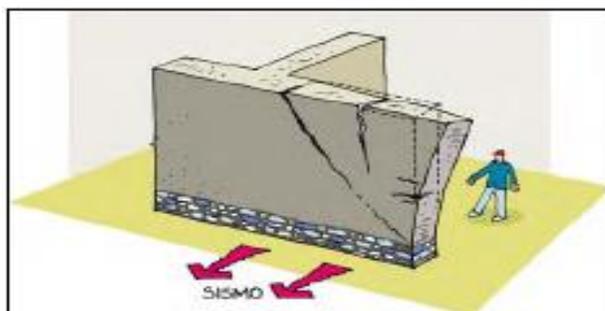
Ilustración de falla por flexión perpendicular al plano del muro con agrietamiento
